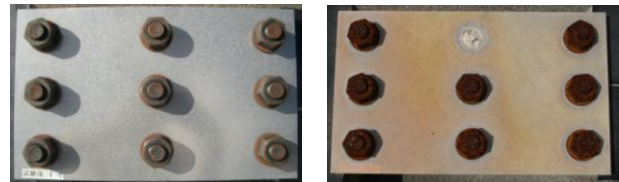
暴露後の状況 (試験体 I-2, フッ素樹脂横置)
